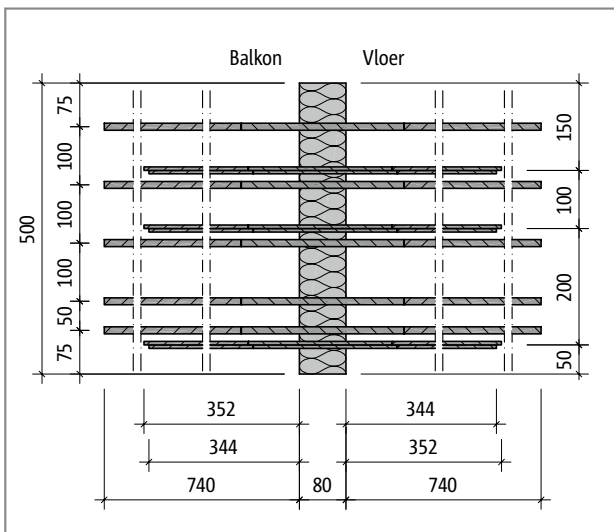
Schöck Isokorb® T type D-MM5-VV3: Overzicht
